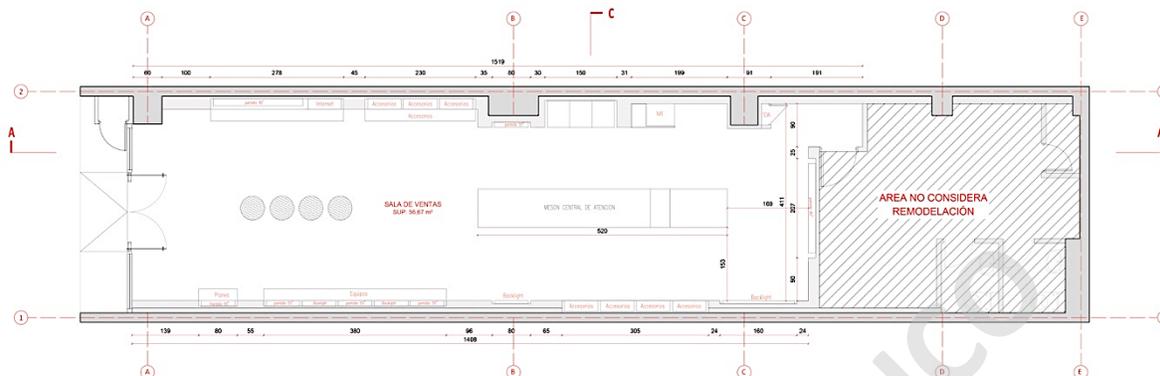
Sucursal Ahumada – Planta Arquitectura.
